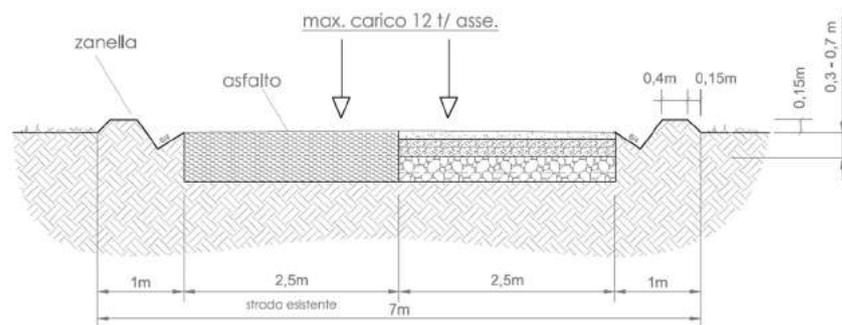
Sezione stradale tipo nel caso di allargamento della sede stradale esistente
